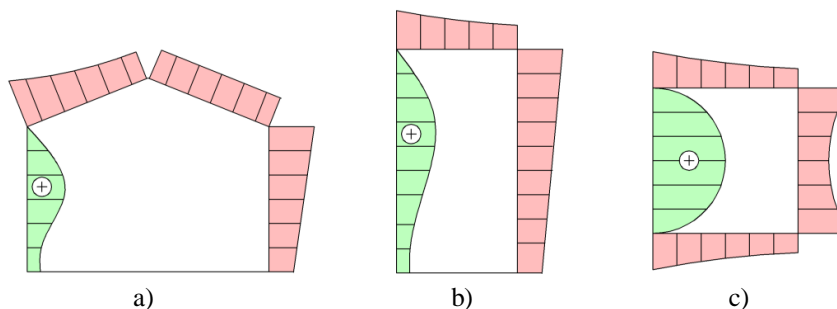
Distribuição do coeficiente de pressão pela acção do vento. a) Edifício com baixo perfil e cobertura inclinada (alçado). b) Edifício com alto perfil e cobertura em terraço (alçado). c) Edifício isolado de planta quadrada (planta). Adaptado de [15].
